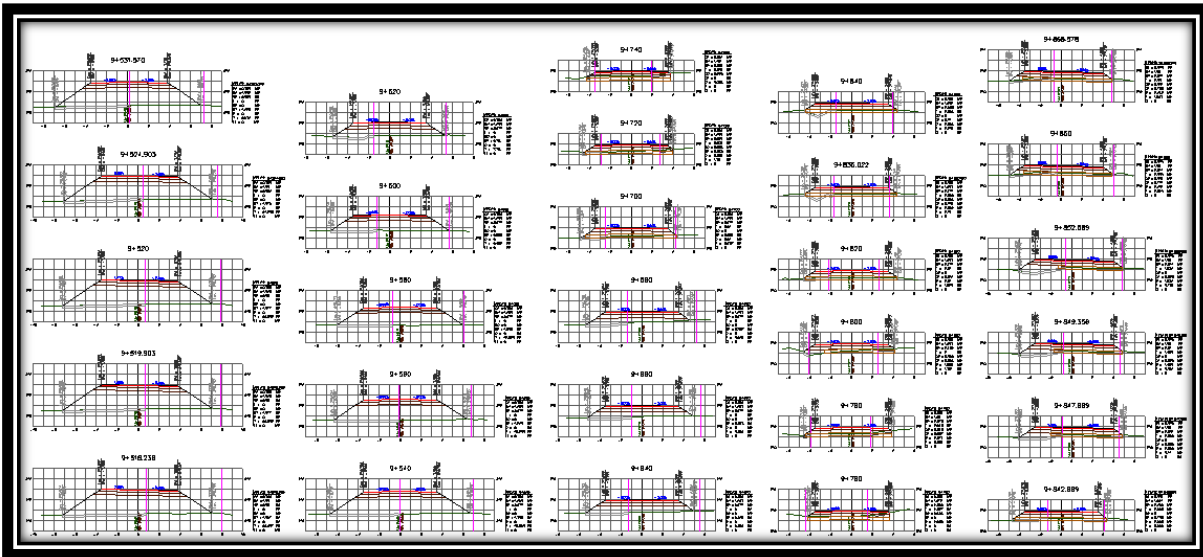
Secciones de construcción del km 9+518.236 al km 9+868.578.
